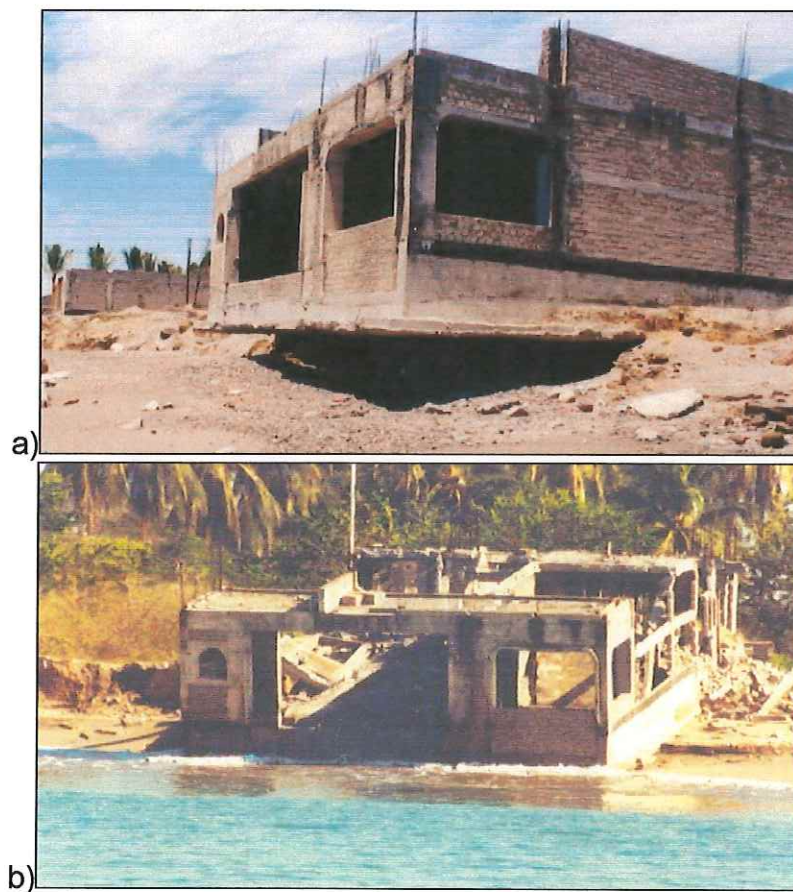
Construcción mal planeada; a) estructura socavada (abril 2003) y b) estructura derrumbada (octubre 2003), playa "El Salado".
